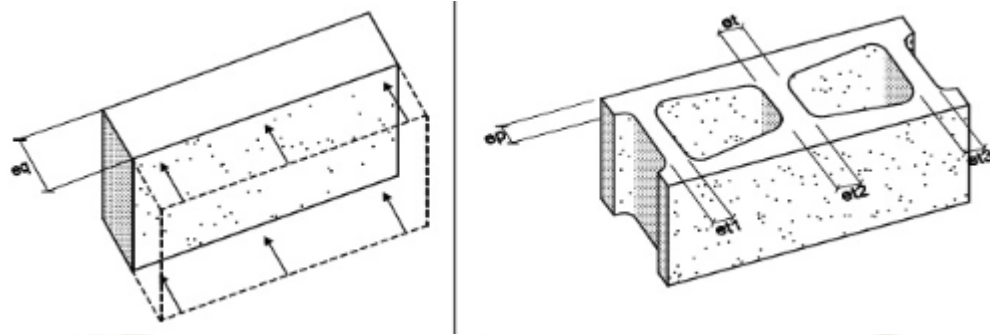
Dimensiones de una unidad de mampostería de concreto.
